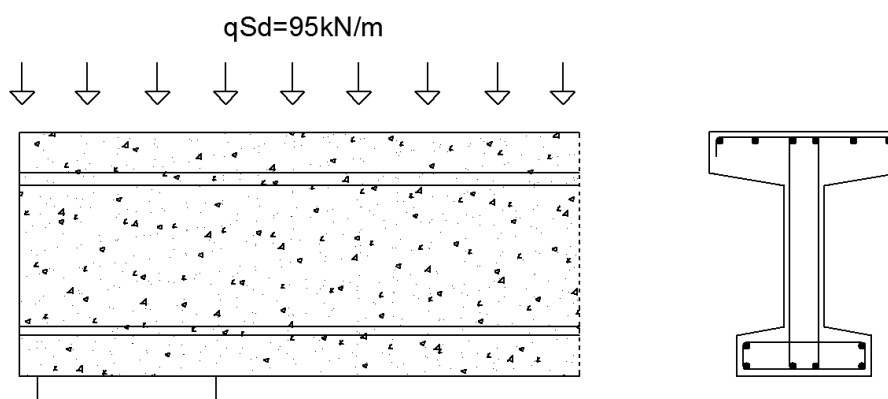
Modelo esquemático da viga de betão armado com secção transversal em I estudada por Regan (Regan, 2009).
